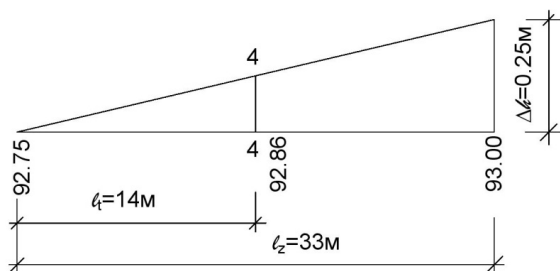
Схема к расчету абсолютных отметок точек на поверхности строительной площадки
